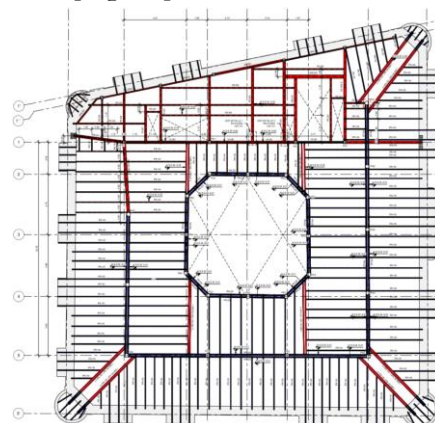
Planta tipo de perfiles metálicos (Proyecto de ejecución).
